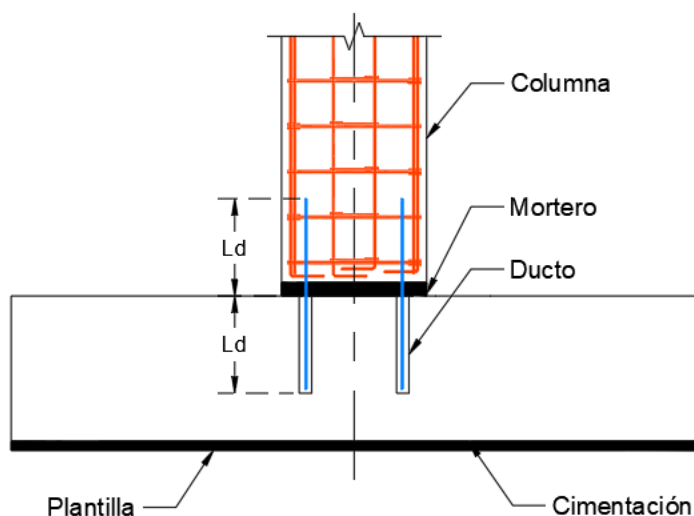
Ejemplo de conexión entre columna prefabricada y cimentación
